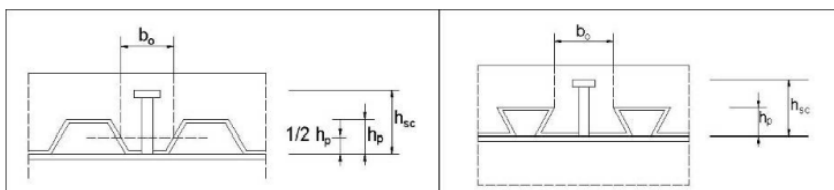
(b) - Disposizione della lamiera grecata rispetto al profilo in acciaio
